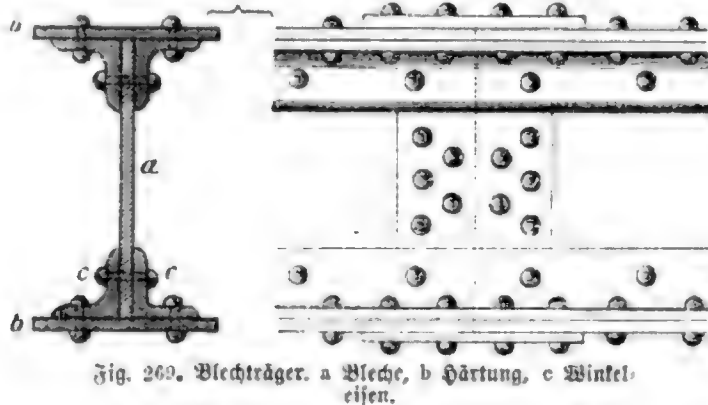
Blechträger. a Bleche, b Härtung, c Winkeleisen.
